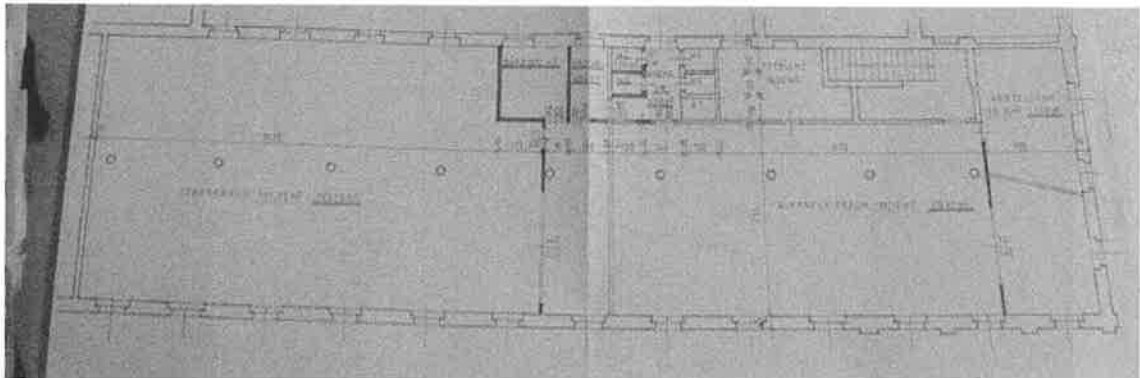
Grundriss 2. Obergeschoss (25)
